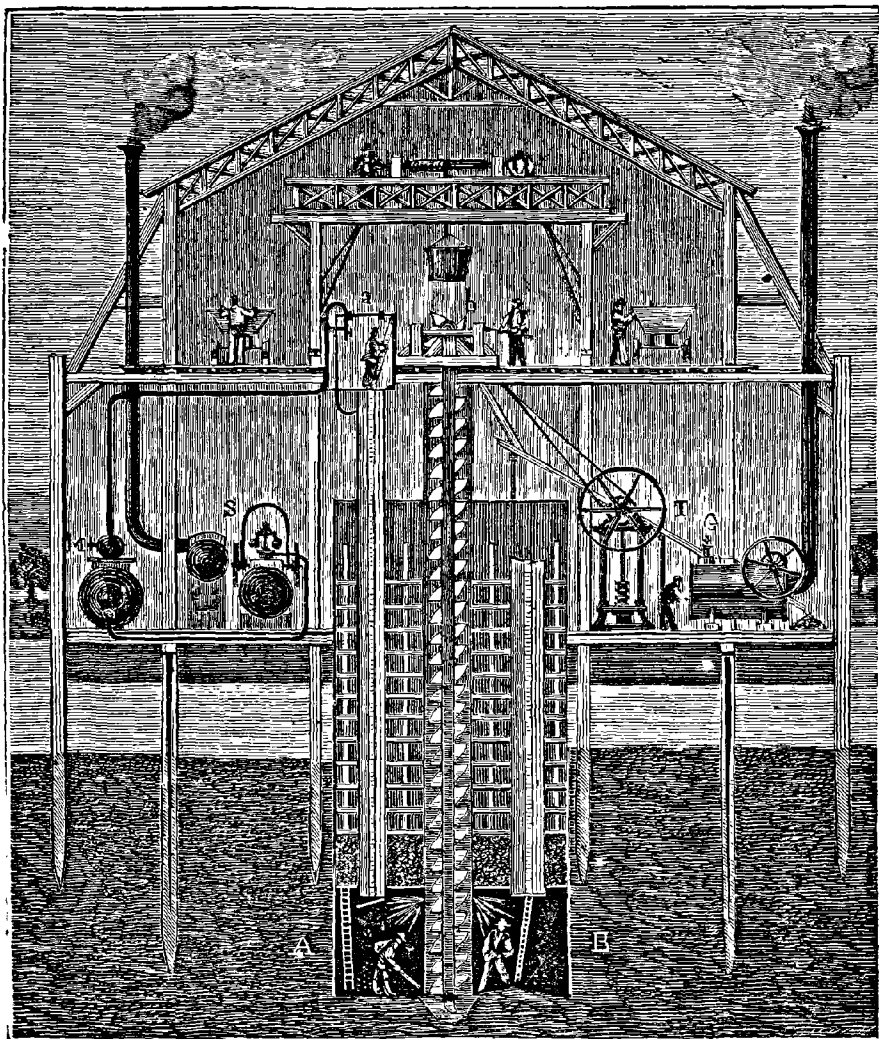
Fondation des piles du pont de Kehl (page 310).
